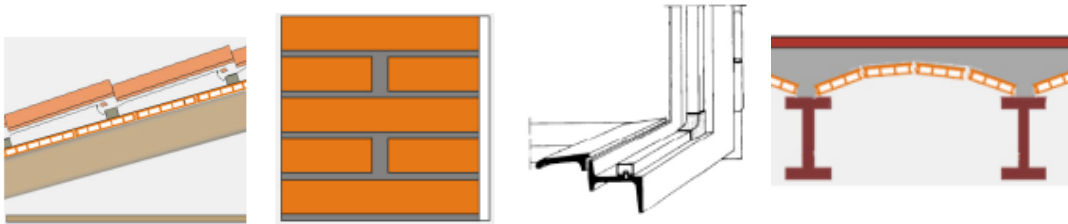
Esquemas constructivos Cubierta, Fachada, Carpintería, Forjado. Fuente TABULA [108]
